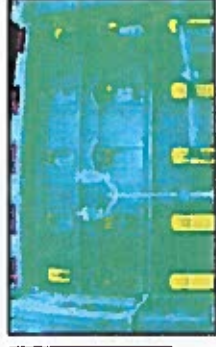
cas d'un plancher simple à poutres accolées assemblées, encastrées dans un caisson en plâtre (allègement 3)
